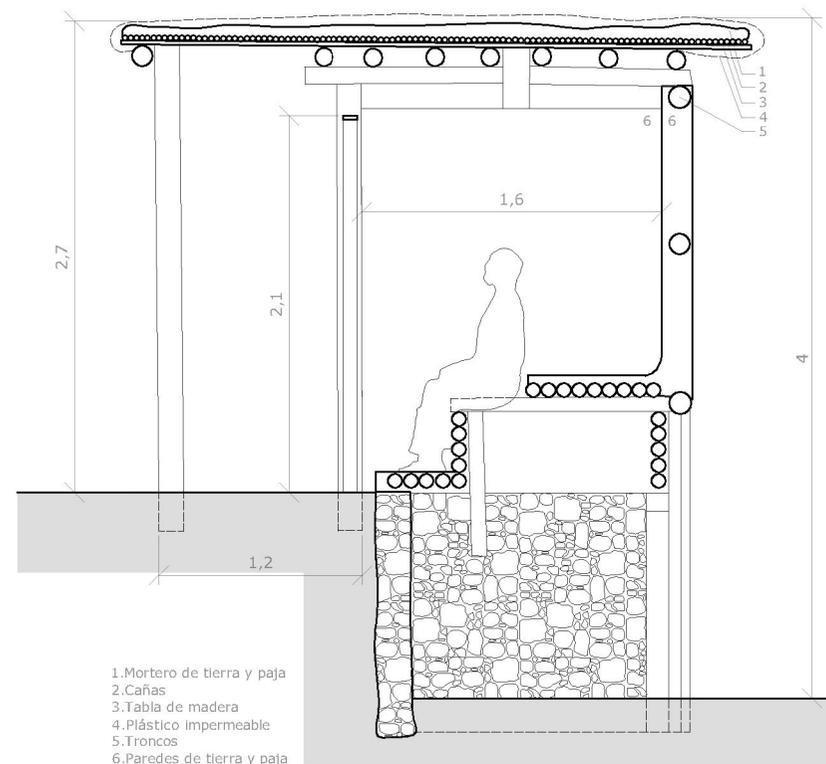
Detalle constructivo aseos E 1:50
